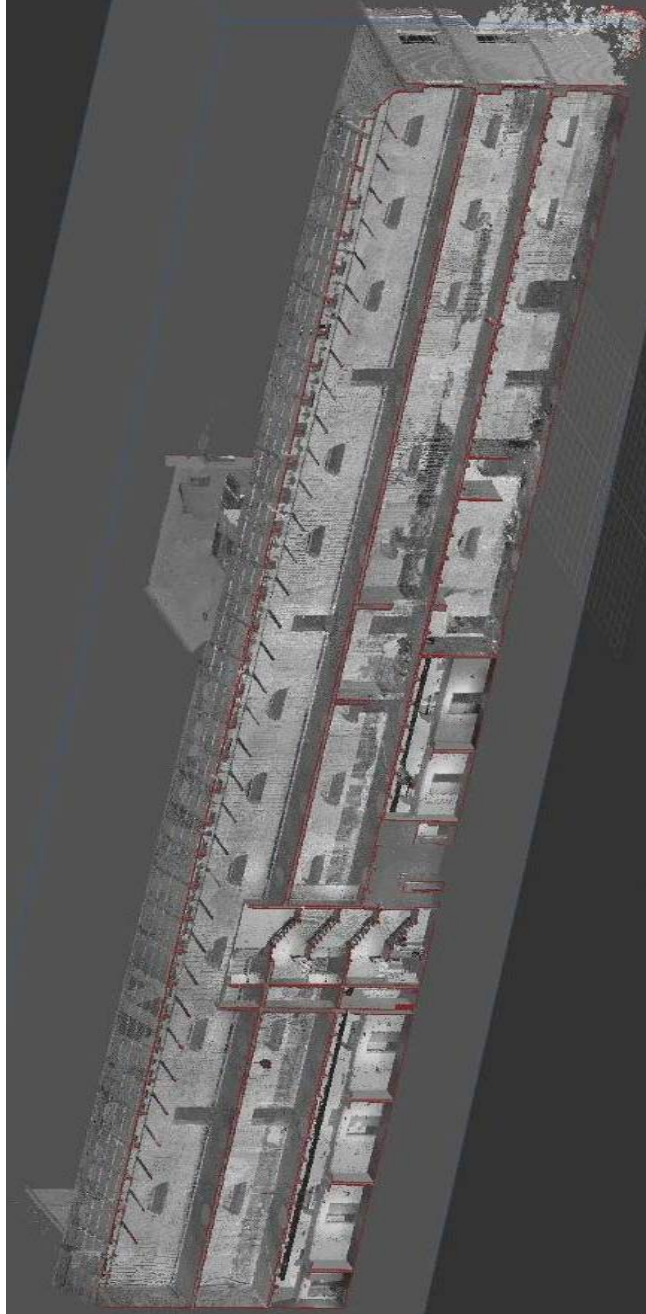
Modello a nuvola di punti sezionato con un piano verticale e longitudinale
